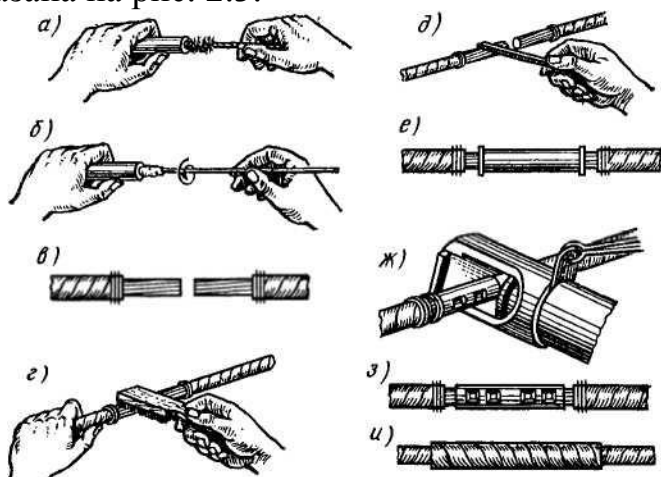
Соединение алюминиевых жил опрессовкой:
